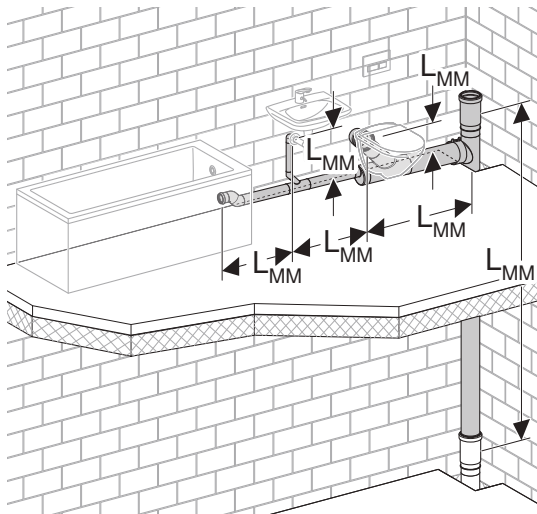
Plan på avloppsprefabricering med framräknade mått (L_{MM})
